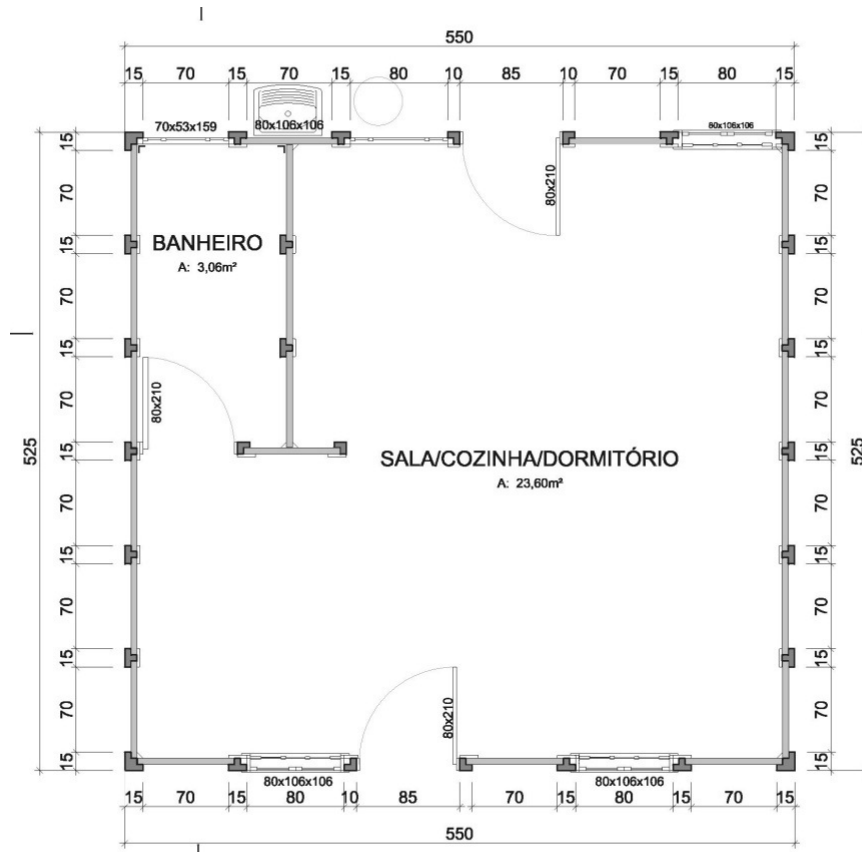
Planta baixa de locação dos pilares do projeto da residência de 29,13m².
